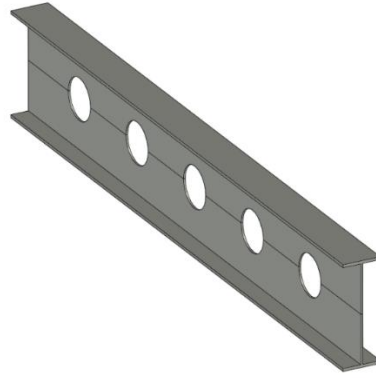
Vista 3D de la viga BOYD formada por el perfil IPE 400.
